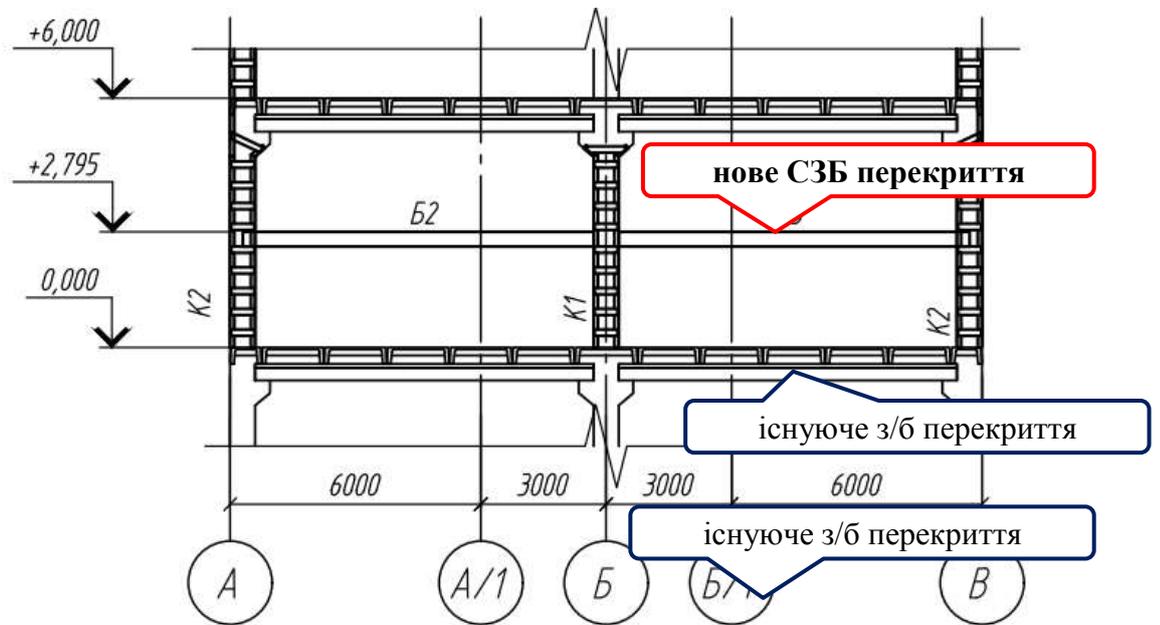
Схема влаштування нових вбудованих сталезалізобетонних перекриттів між існуючими залізобетонними
